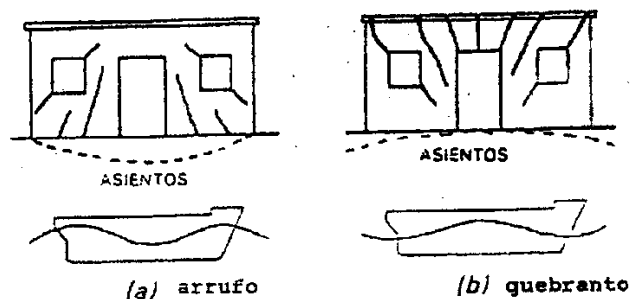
Grietas tipo “Arrufo” (a) y “Quebranto” (b) (Frankie 2013)
